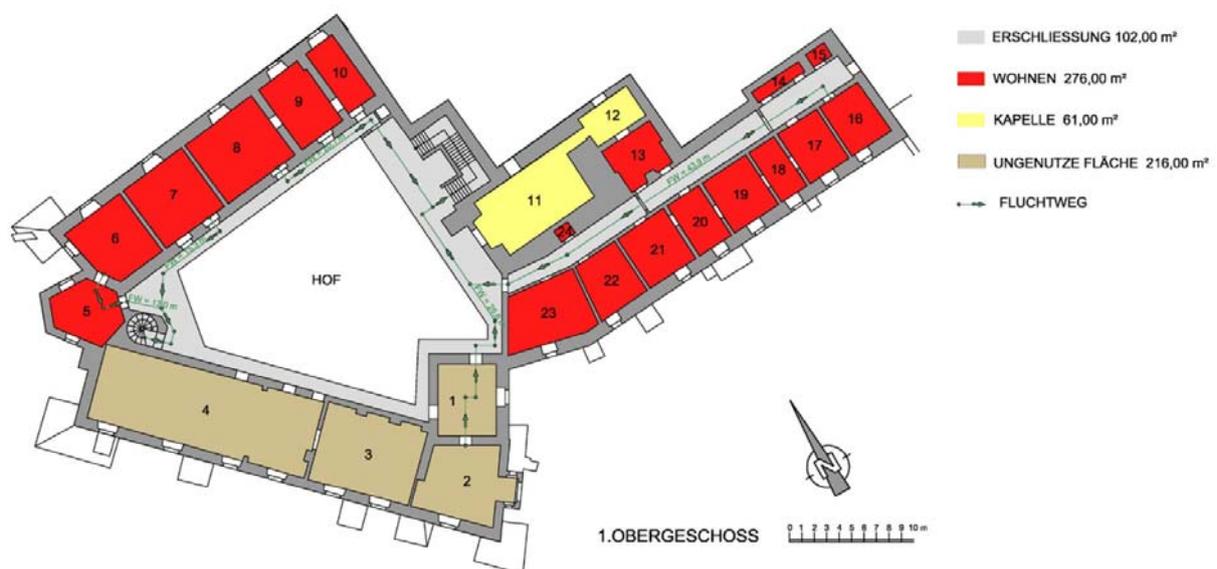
zeigt den Grundriss des Schlosses Matzen im 1.Obergeschoß
